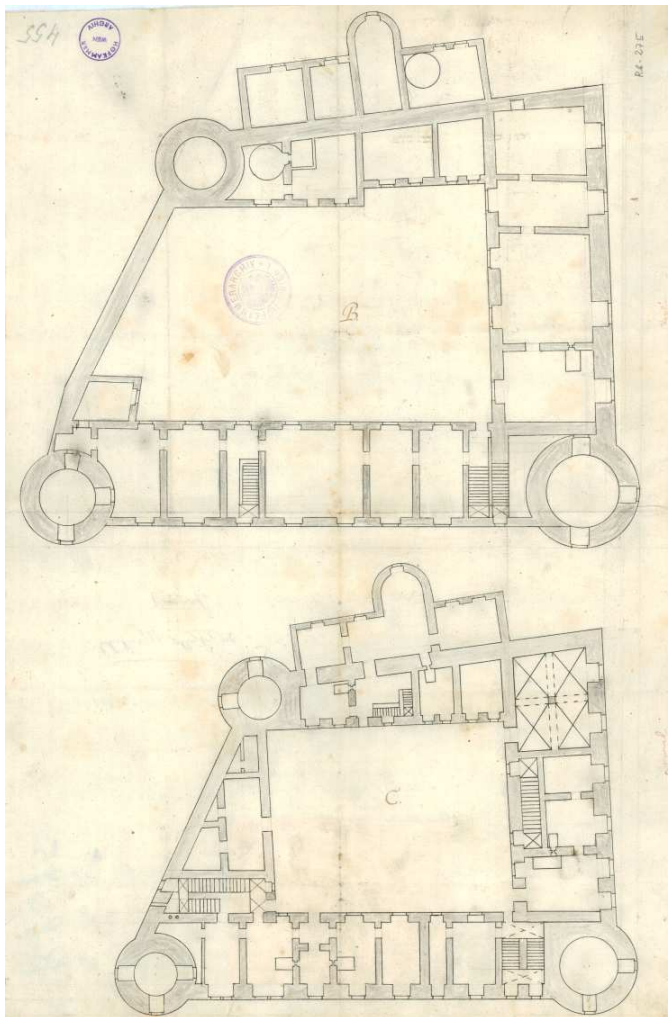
Bestandsaufnahme des Schloss Marchegg, Grundriss beider Geschosse 1624
